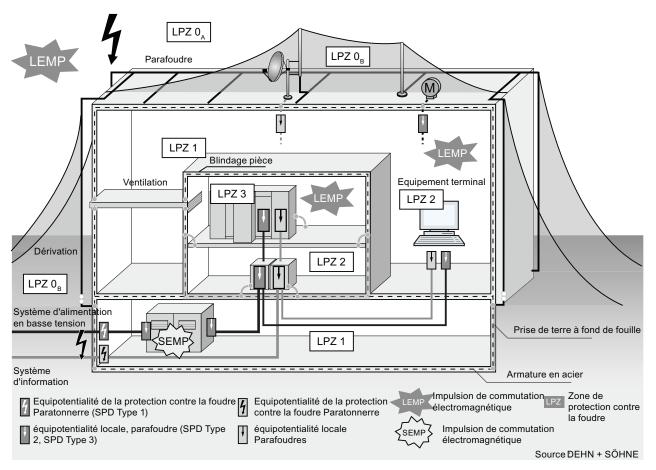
Zones de protection contre la foudre d'un bâtiment avec protection externe
